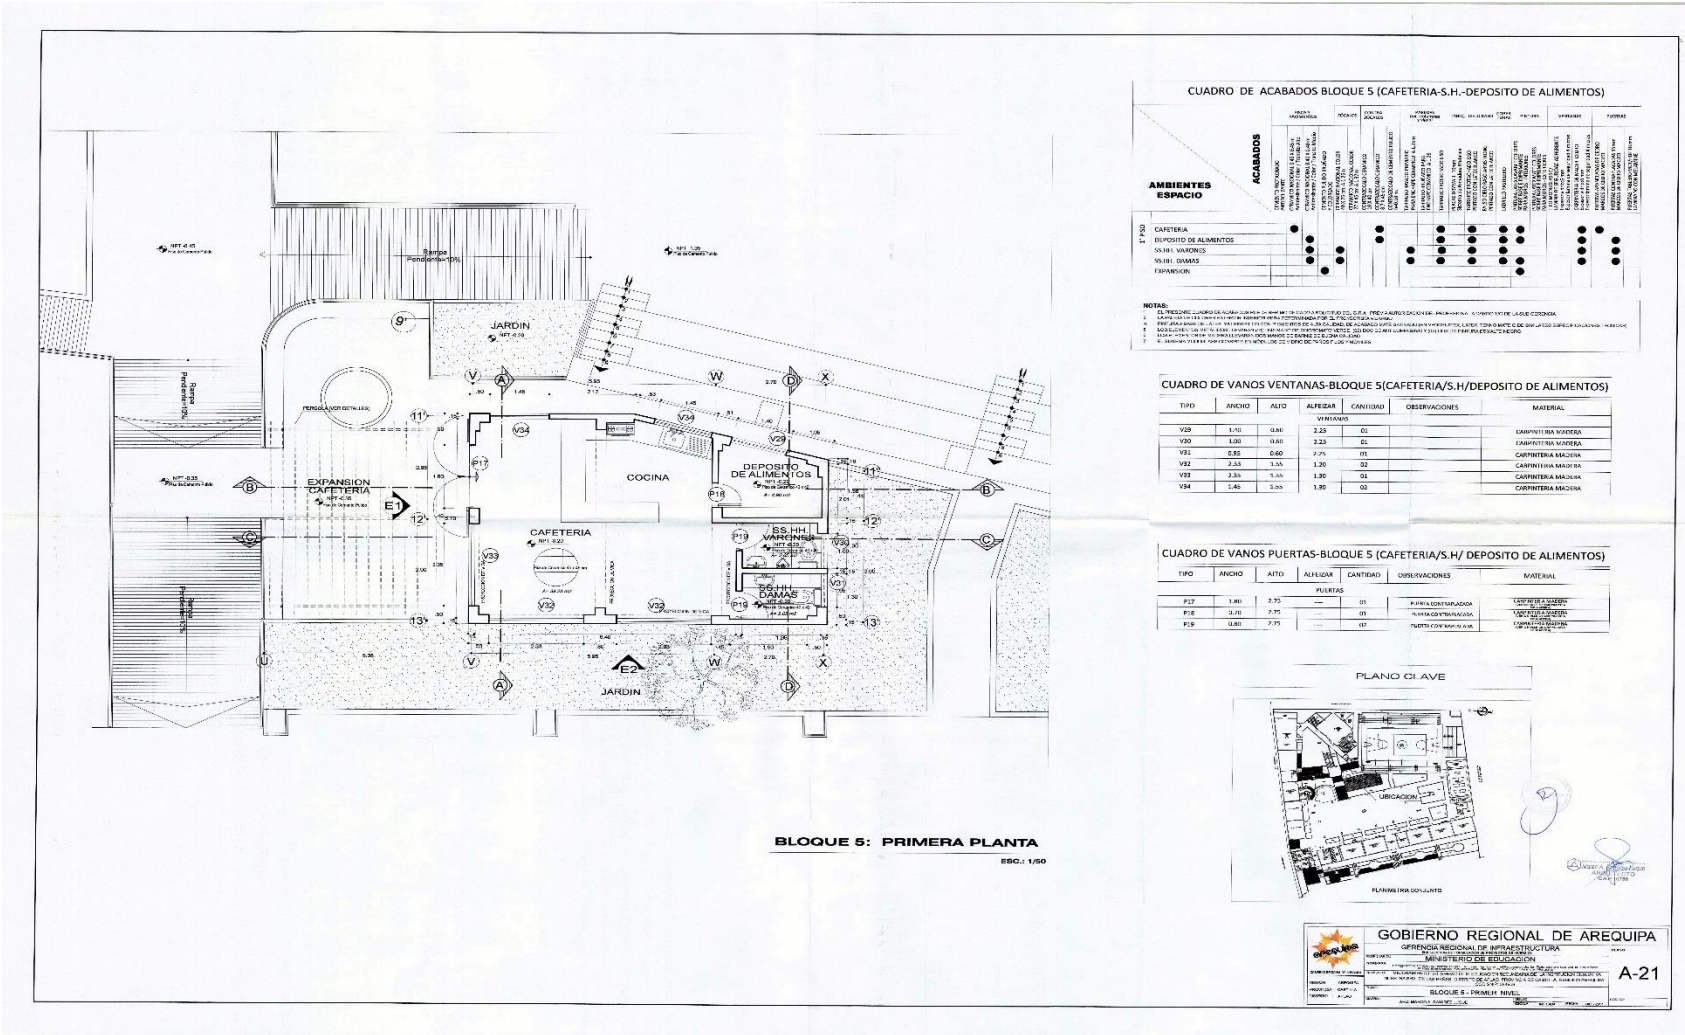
Plano de arquitectura – Planta del bloque 05 cafetería.
